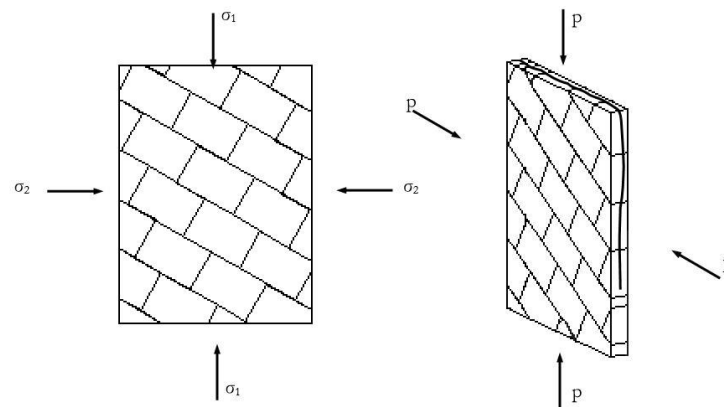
Fissuration (Plan parallèle), [Page, 1981]
